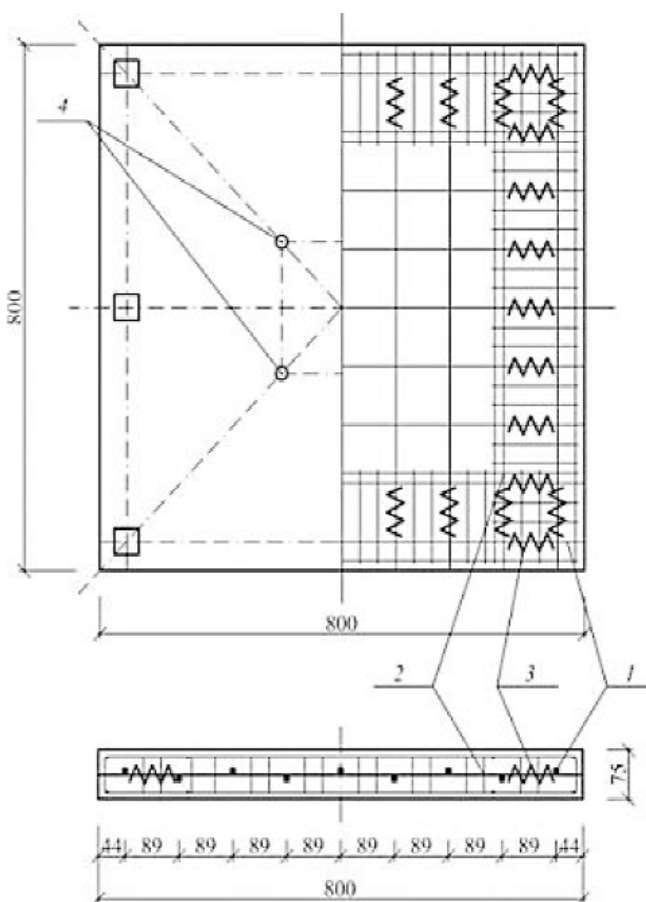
Армування випробувальних плит-зразків: 1 – арматурні стержні; 2 – "П" – подібні арматурні сітки; 3 – спіралі; 4 – круглі марки.
